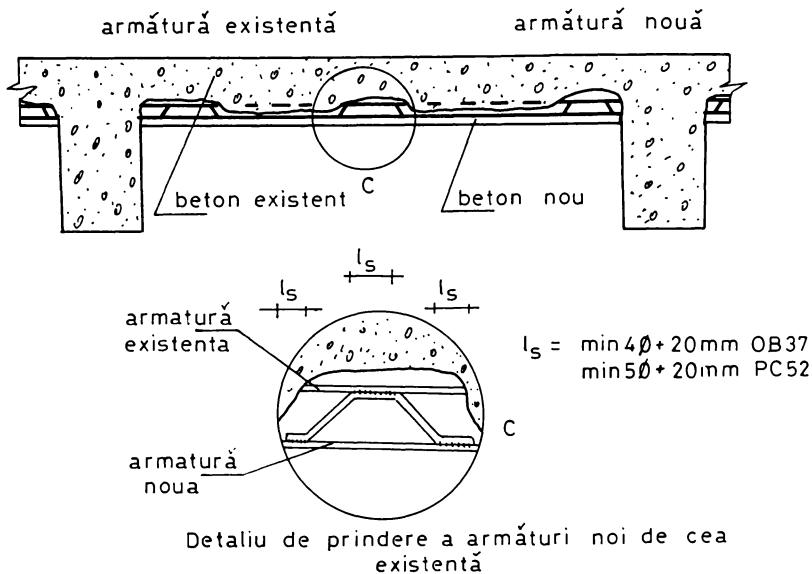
Consolidarea plăcilor de beton armat la partea inferioară
